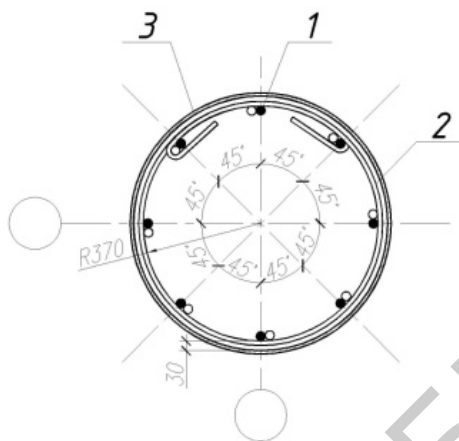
Запроектированное поперечное сечение колонны: 1- рабочая арматура; 2- хомут; 3- стальная труба
